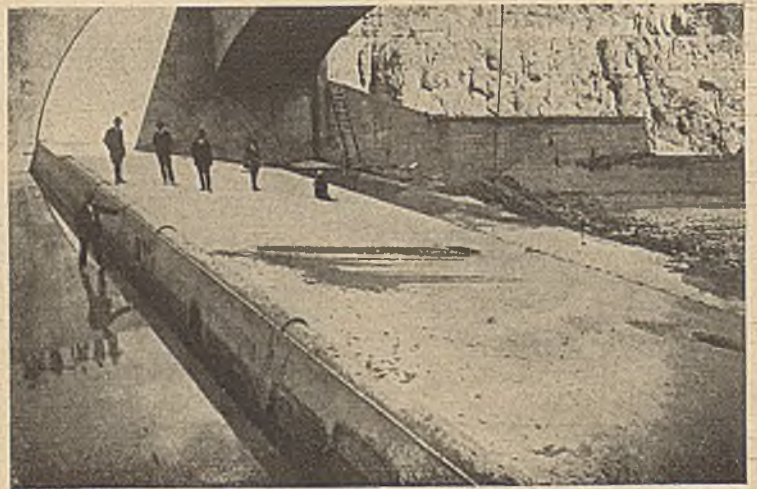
Eisenbetonsektorwehr Camarasa (Spanien) der Riegos y Fuerza del Ebro S. U. Barcelona. (Ausführung Stauwerke A. G.)
